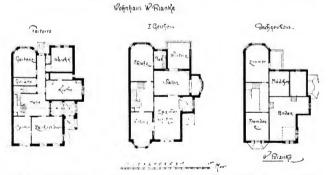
Grundrisse des Wohnhauses W. Blanke. W. Blanke und Herm. Meyer. 1898.
